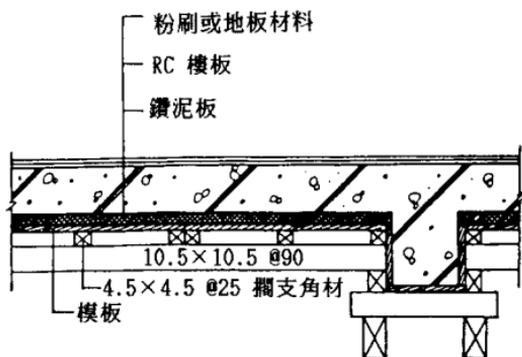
木絲水泥板隔熱施工示意圖(鋼筋混凝土造)
